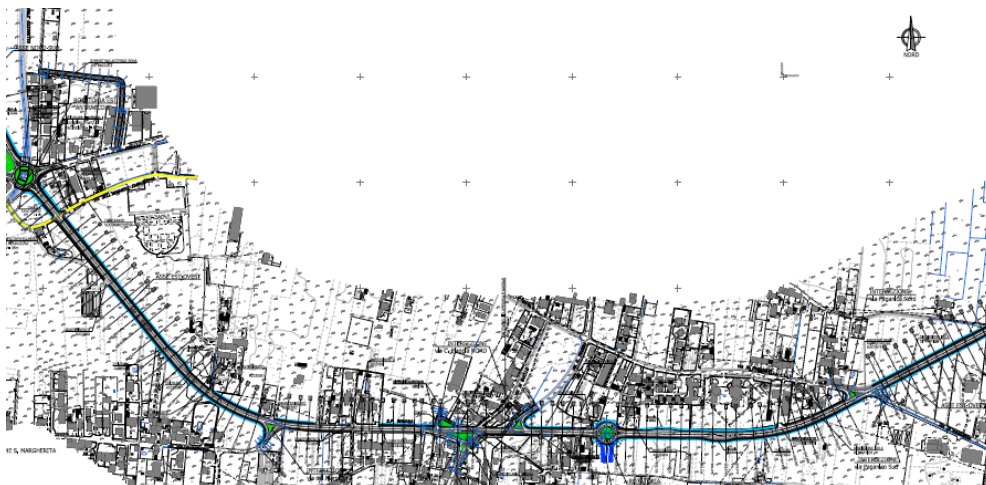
Asse Est-Ovest – Planimetria di progetto stralcio 1/3
